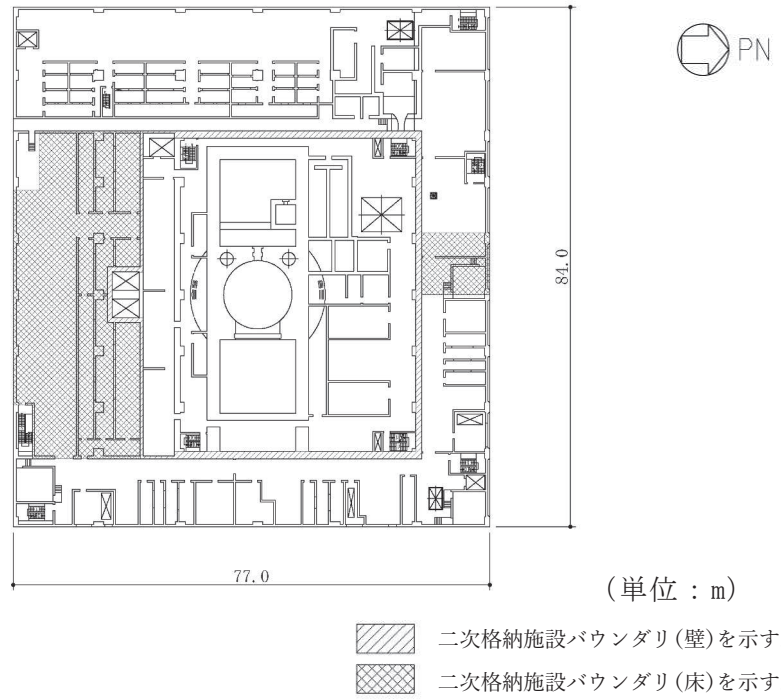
(5) 原子炉建屋原子炉棟（二次格納施設）の範囲の平面図
